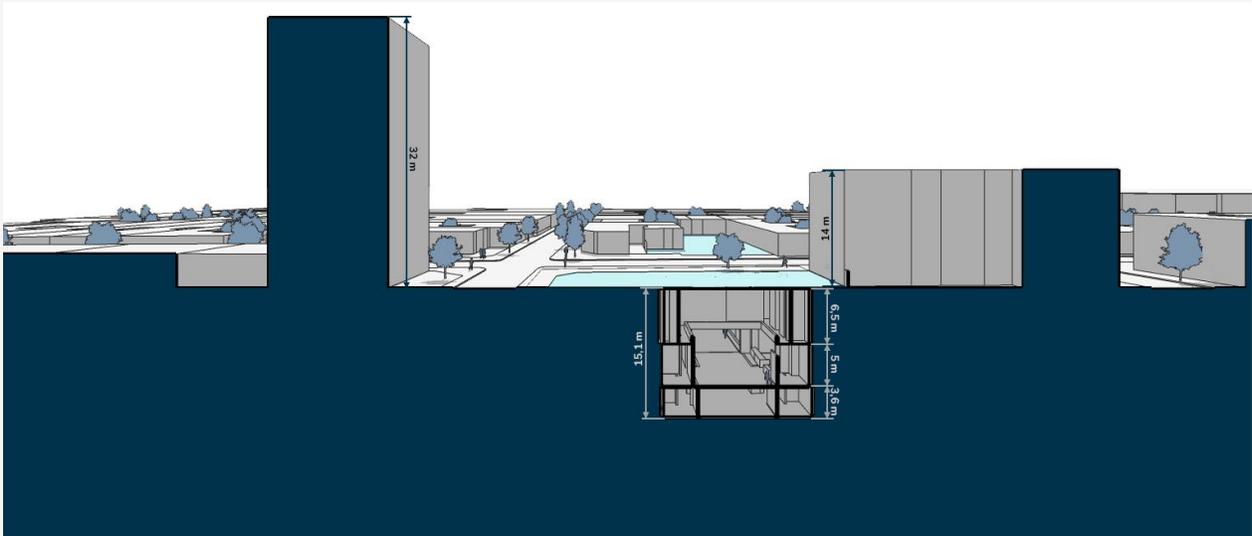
Corte transversal 1, situación actual Fuente: Elaboración propia.
